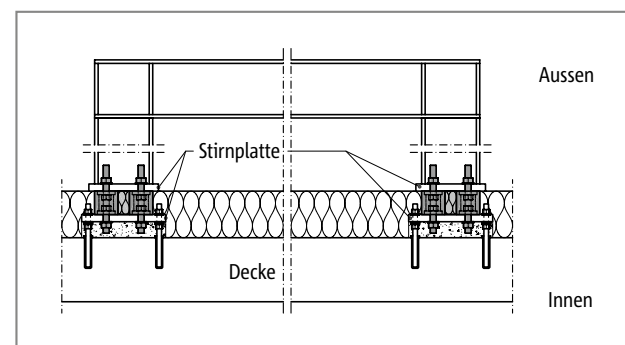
Schöck Isokorb® T Typ S-V: biegesteifer Rahmenanschluss für Sekundärkonstruktionen (zusätzliche Momente aus Imperfektionen sind zu berücksichtigen)
